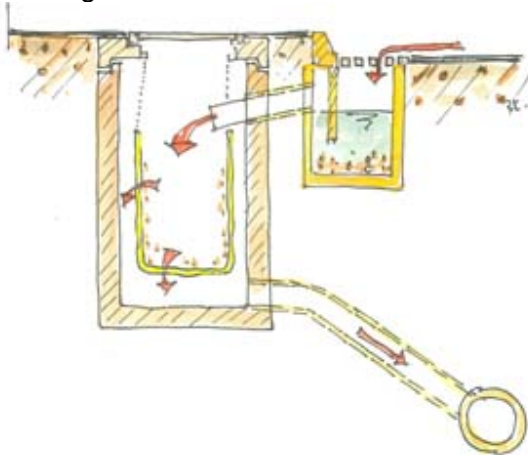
Schachtbauwerk aus einem monolithisches Betonfertigteile.
